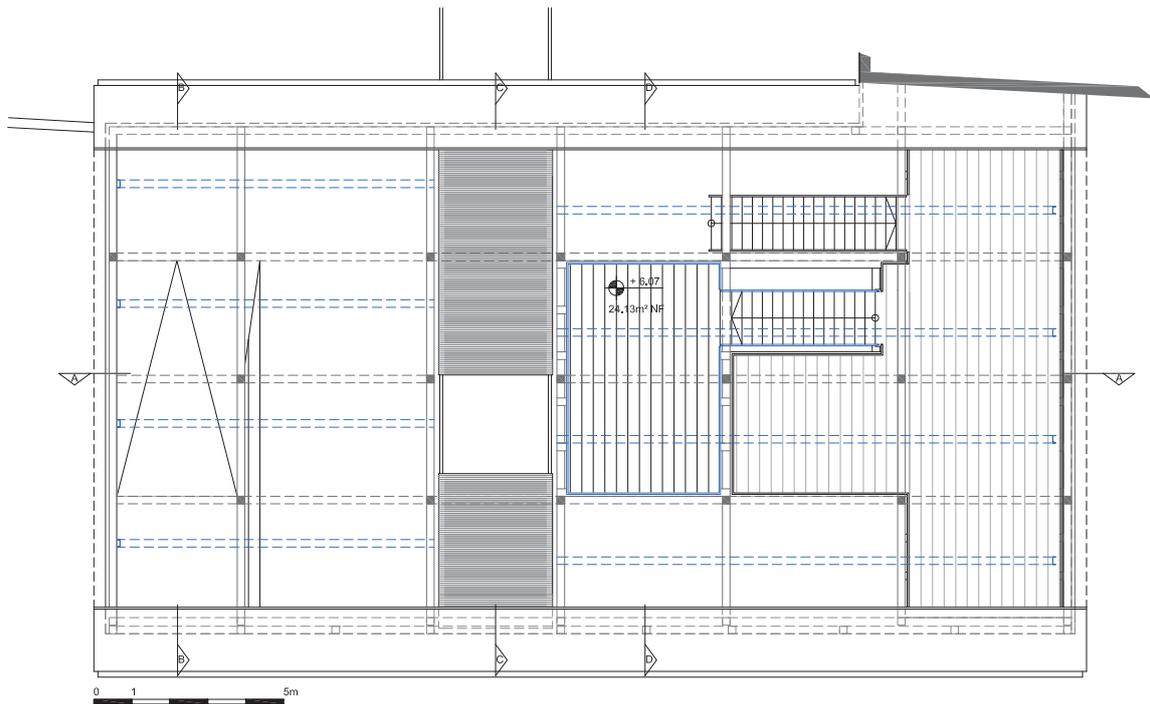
, Grundriss Ebene +6.07 M 1 : 200
